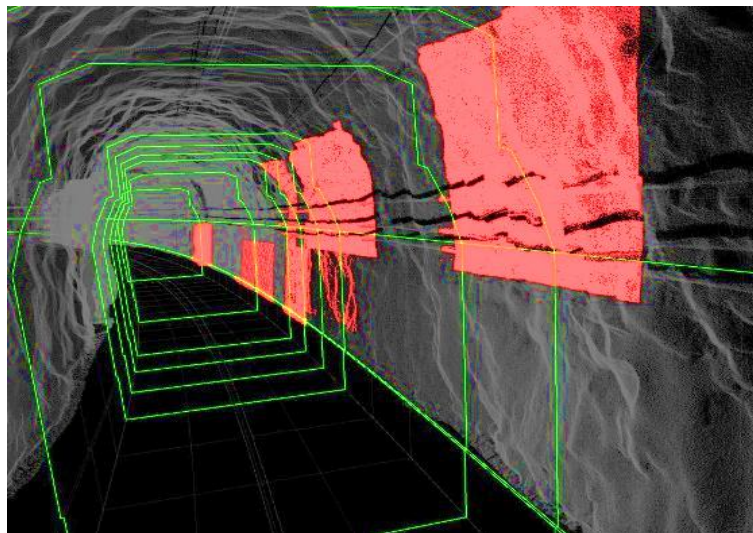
Detalle de la colisión del gálibo con las instalaciones presentes en el túnel. Fuente: Elaboración propia (2018).
